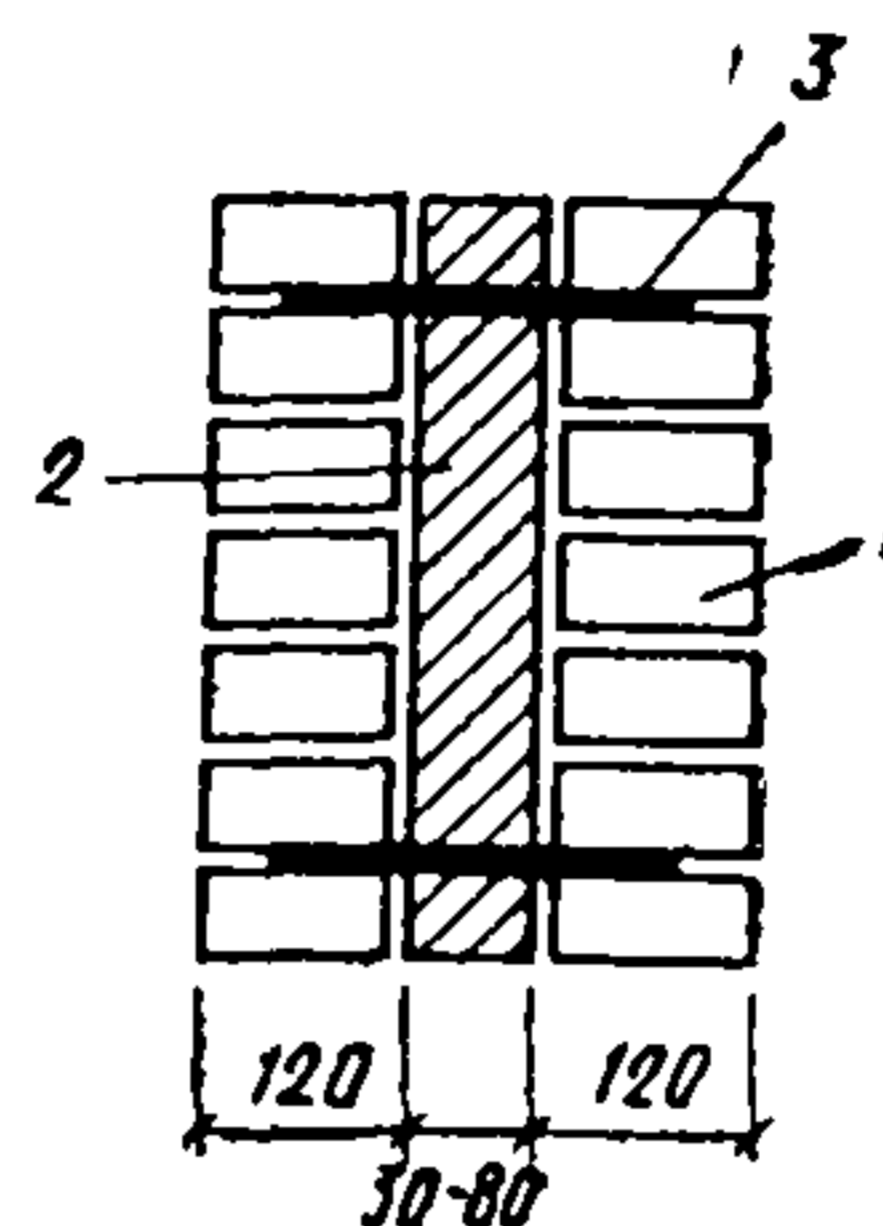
Стена типа VI с теплоизоляцией внутри кладки
